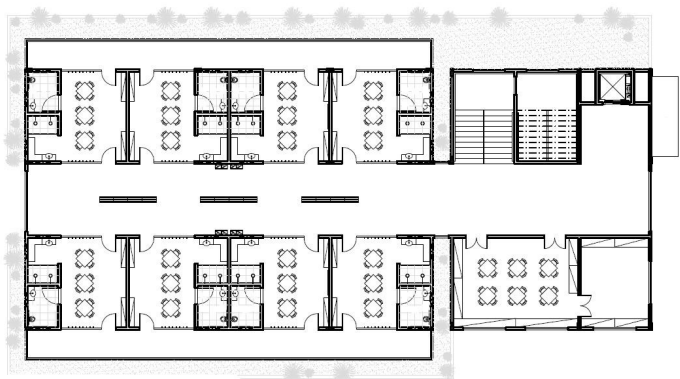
Planta Baixa – Bloco do Ensino I – Pav. Superior.
